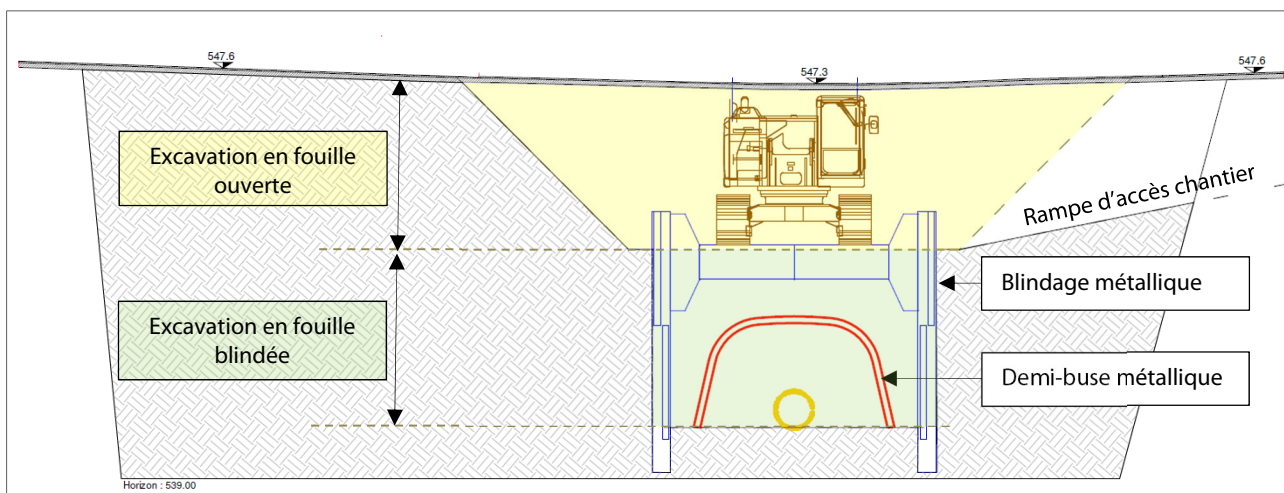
Evaluation 1, installation d'une demi-buse, coupe transversale
